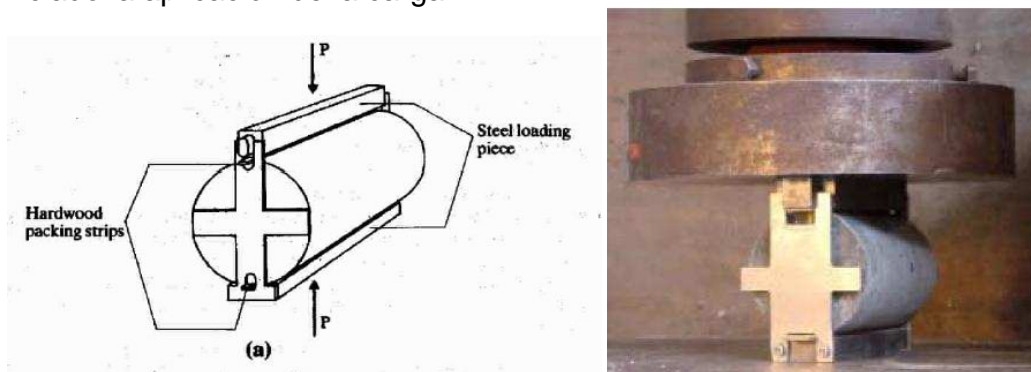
Cilindro sujeto a la prueba de tensión.
